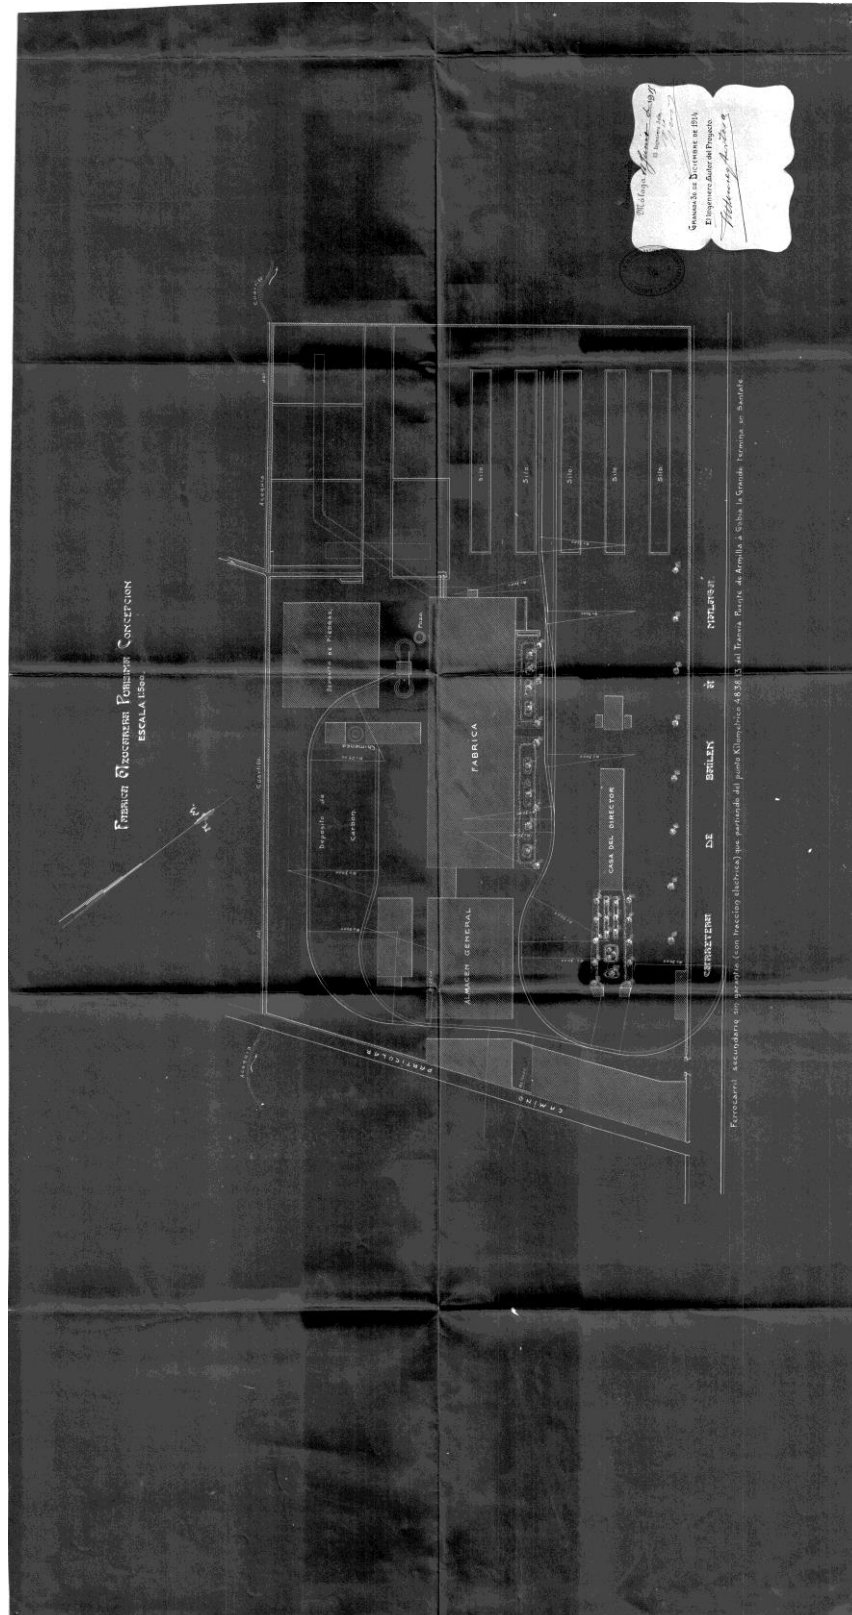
Proyecto del acceso tranviario a la Fábrica Azucarera "La Purísima": planta de las instalaciones. Fuente: Archivo M^o Fomento.
